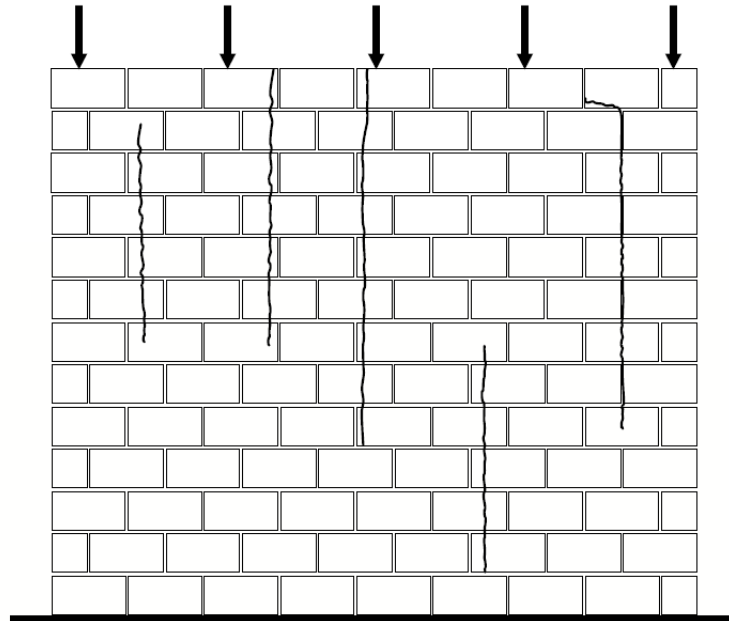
Estado de fissuração de alvenaria submetida a carregamento uniformemente distribuído.
